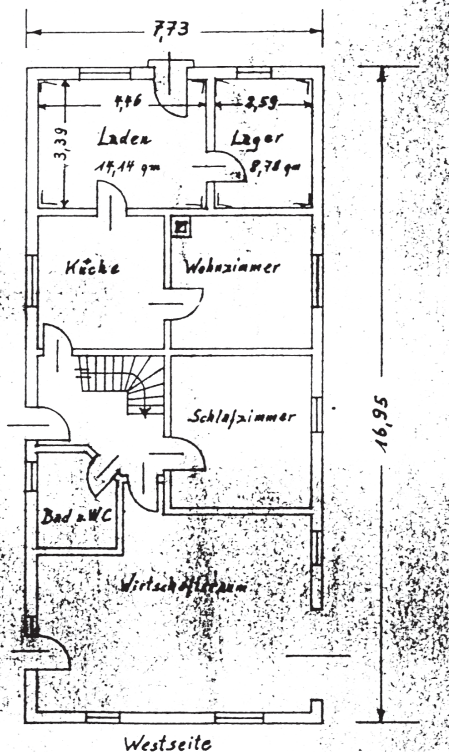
Grundriss vom Erdgeschoss mit Position von Laden und Lager. Dieser Plan musste dem Konzessionsantrag für den Kleinhandel mit Branntwein beigelegt werden. Die Erlaubnis wurde 1965 erteilt. [Quelle: Privat].
